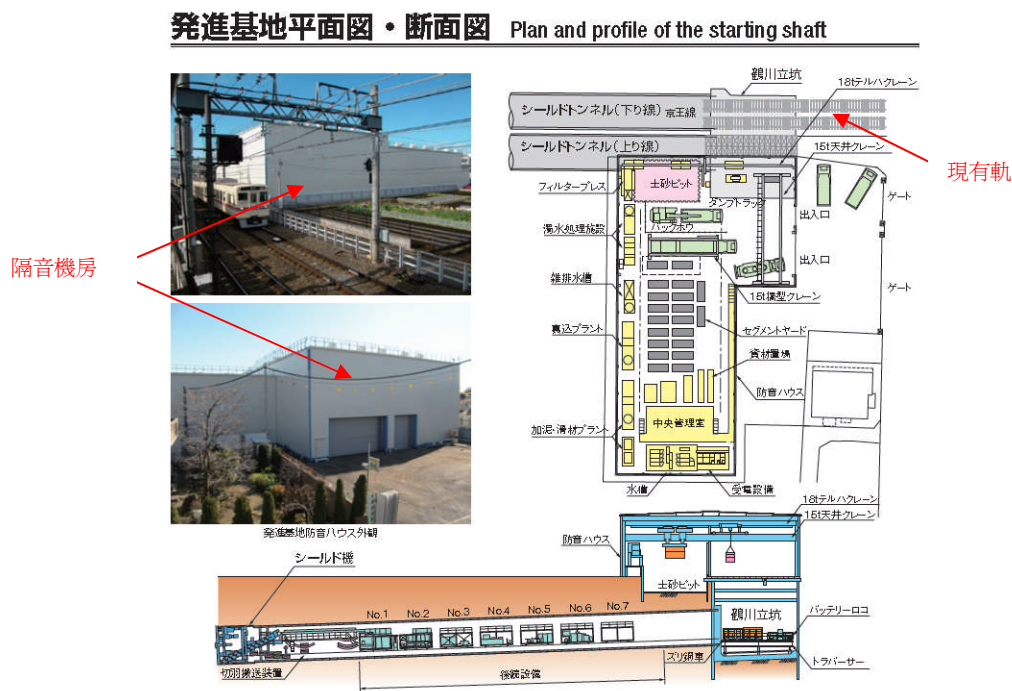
調布市鐵路立體化第四工區潛盾施工工作井平面圖
